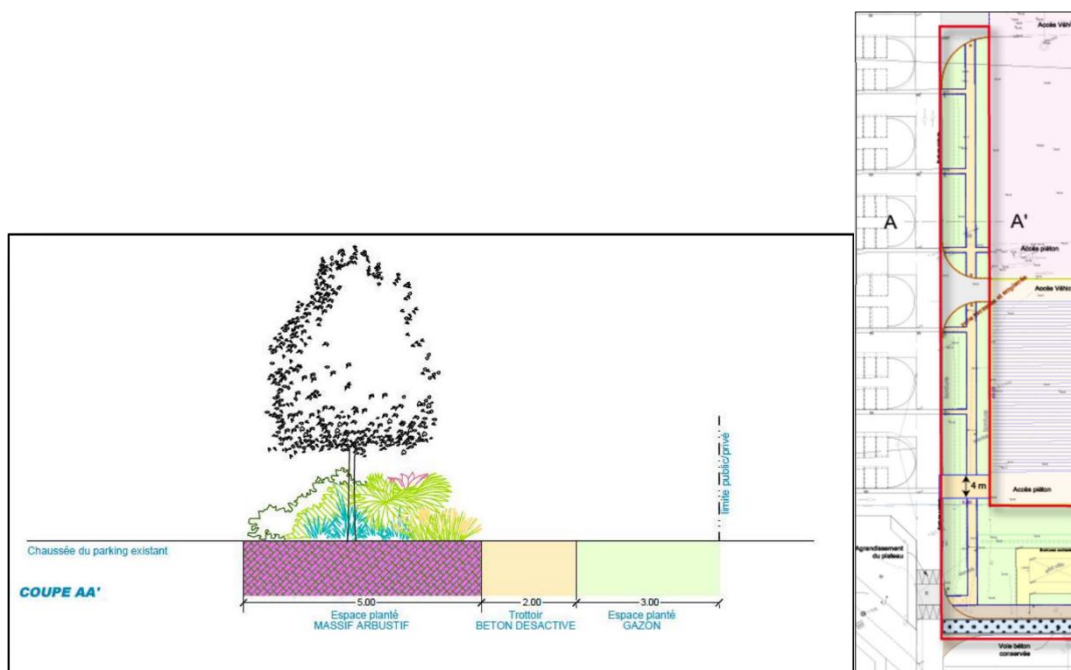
Plan et coupe du cheminement piéton nord-sud (source : Valence Romans agglo)
